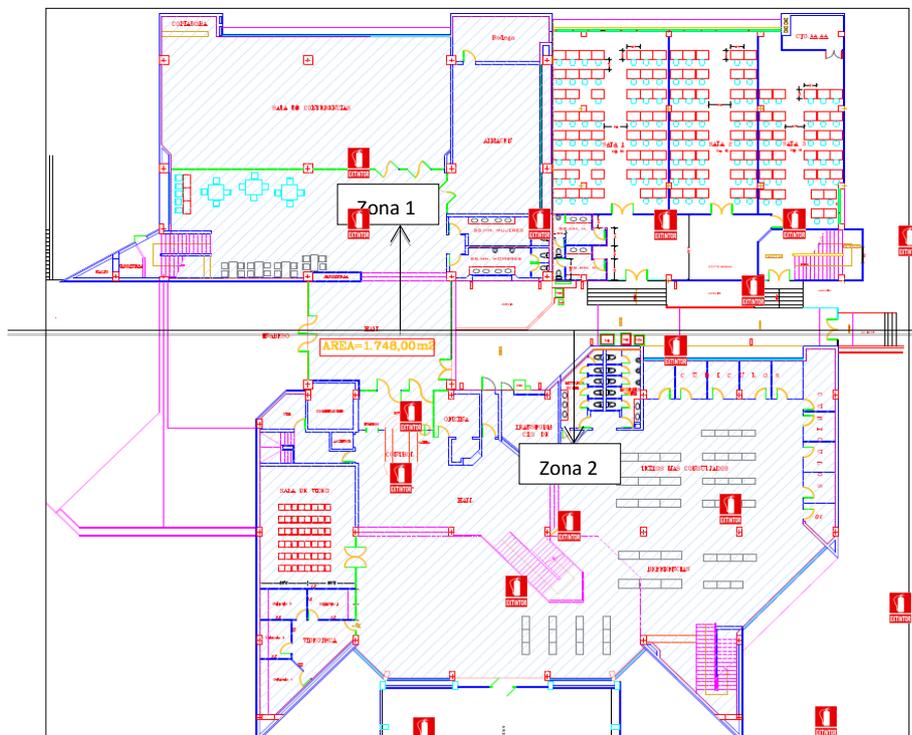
Extintores, Planta Baja, Zona 1 y 2
